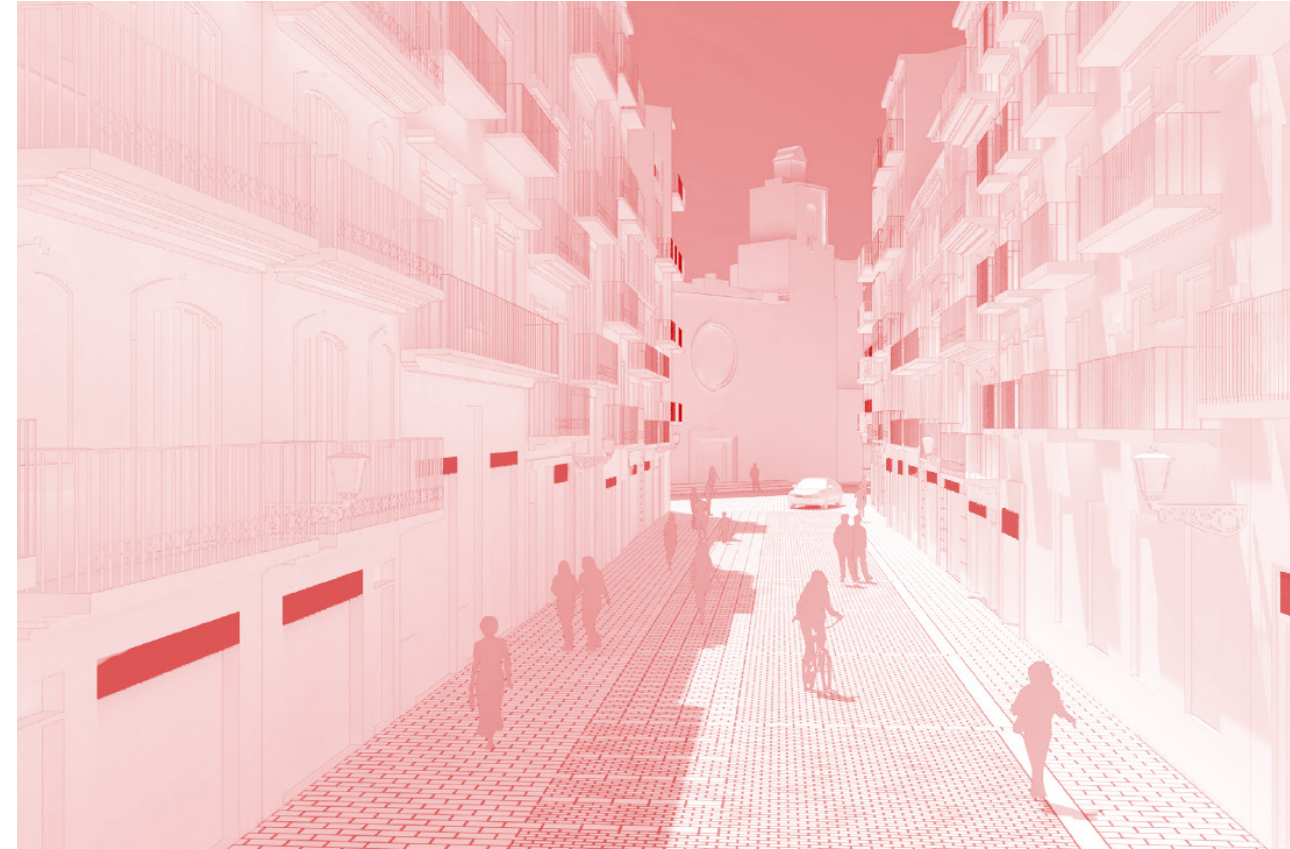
Preservación del plano de fachada e integración de la cartelería y artefactos en fachadas.
